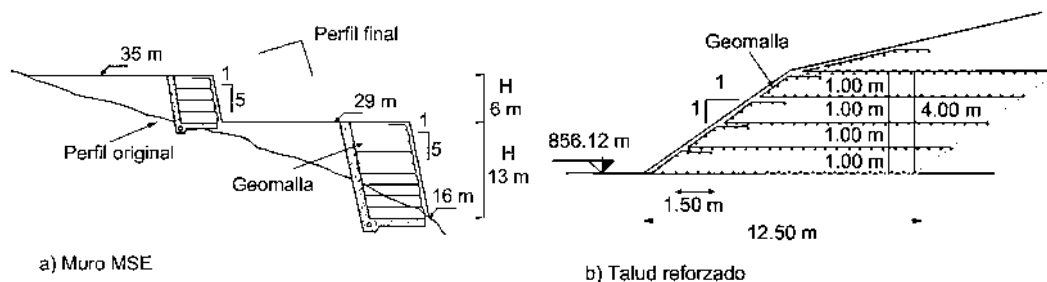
Tipos de estructuras de suelo con refuerzo.
